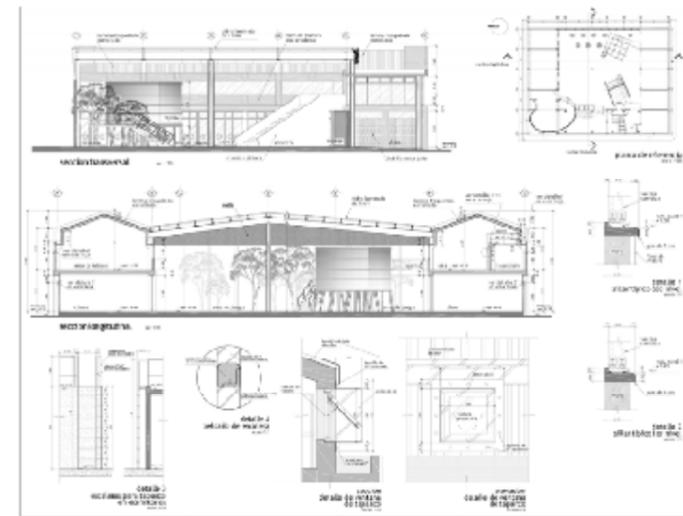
Planos arquitectónicos, cortes y detalles constructivos del Centro Comunitario Chalco.
